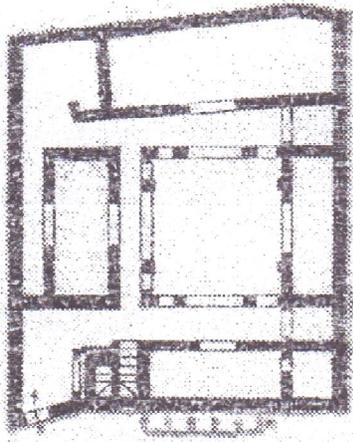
مسقط أفقي للطابق الأول لسلسلة تلمسان
